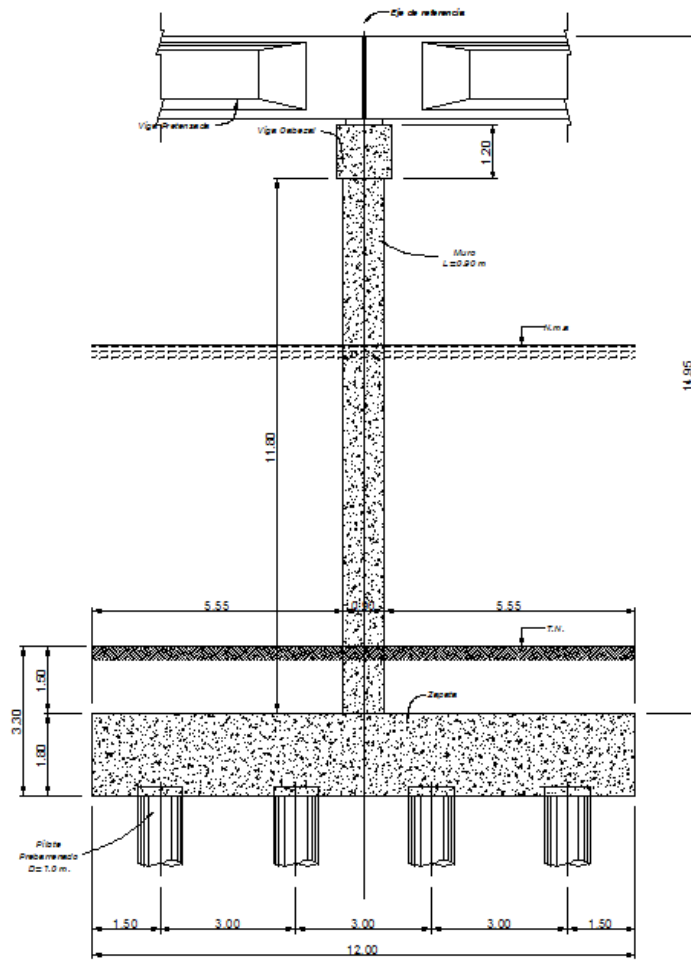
Distribución lateral de pilotes para la pila P3.
